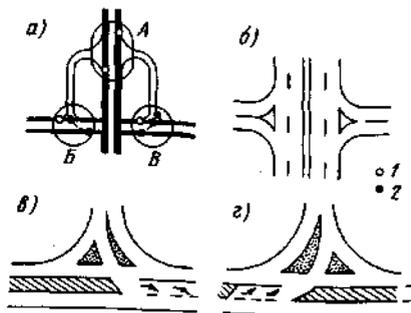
Планировочное решение неполного пересечения в разных уровнях: а — схема развязки; б — планировка узла А; в — планировка узла В; г — планировка узла В; 1 — точки слияния потоков; 2 — конфликтные точки, образуемые левоворотными потоками
